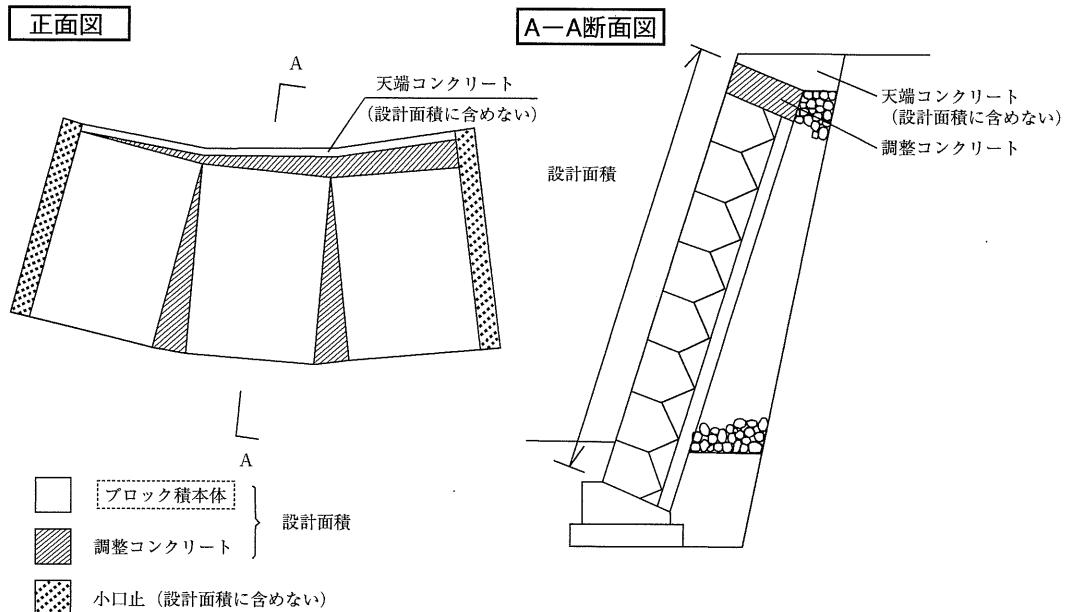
コンクリートブロック積工(調整コンクリート・小口止)参考図
